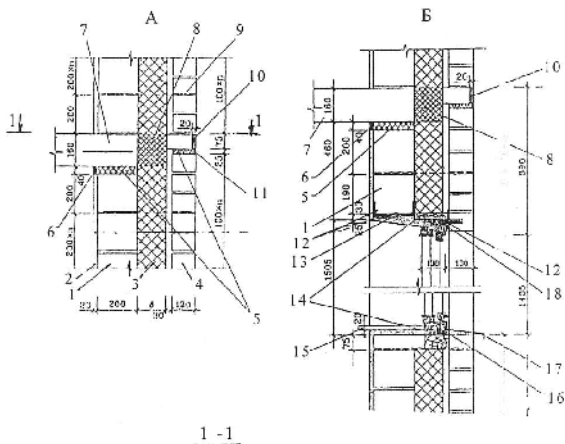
Трехслойная стена из газобетонных блоков с эффективным утеплителем и облицовкой кирпичом: А – сечение по простенку; Б – сечение по оконному проему; 1 – блок из ячеистого бетона, 2 – штукатурка, 3 – утеплитель, 4 – лицевой кирпич, 5 – упругая прокладка, 6 – мастика, 7 – плита перекрытия, 8 – негорючий утеплитель, 9 – горизонтальное армирование кладки, 10 – декоративная плитка, 11 – расшивка, 12 – глухой уголок, 13 – штукатурка откоса, 14 – пеноуплотнитель (полиуретан), 15 – лощокинная доска, 16 – герметизирующая эластичная лента, 17 – слив, 18 – герметизирующая мастика
